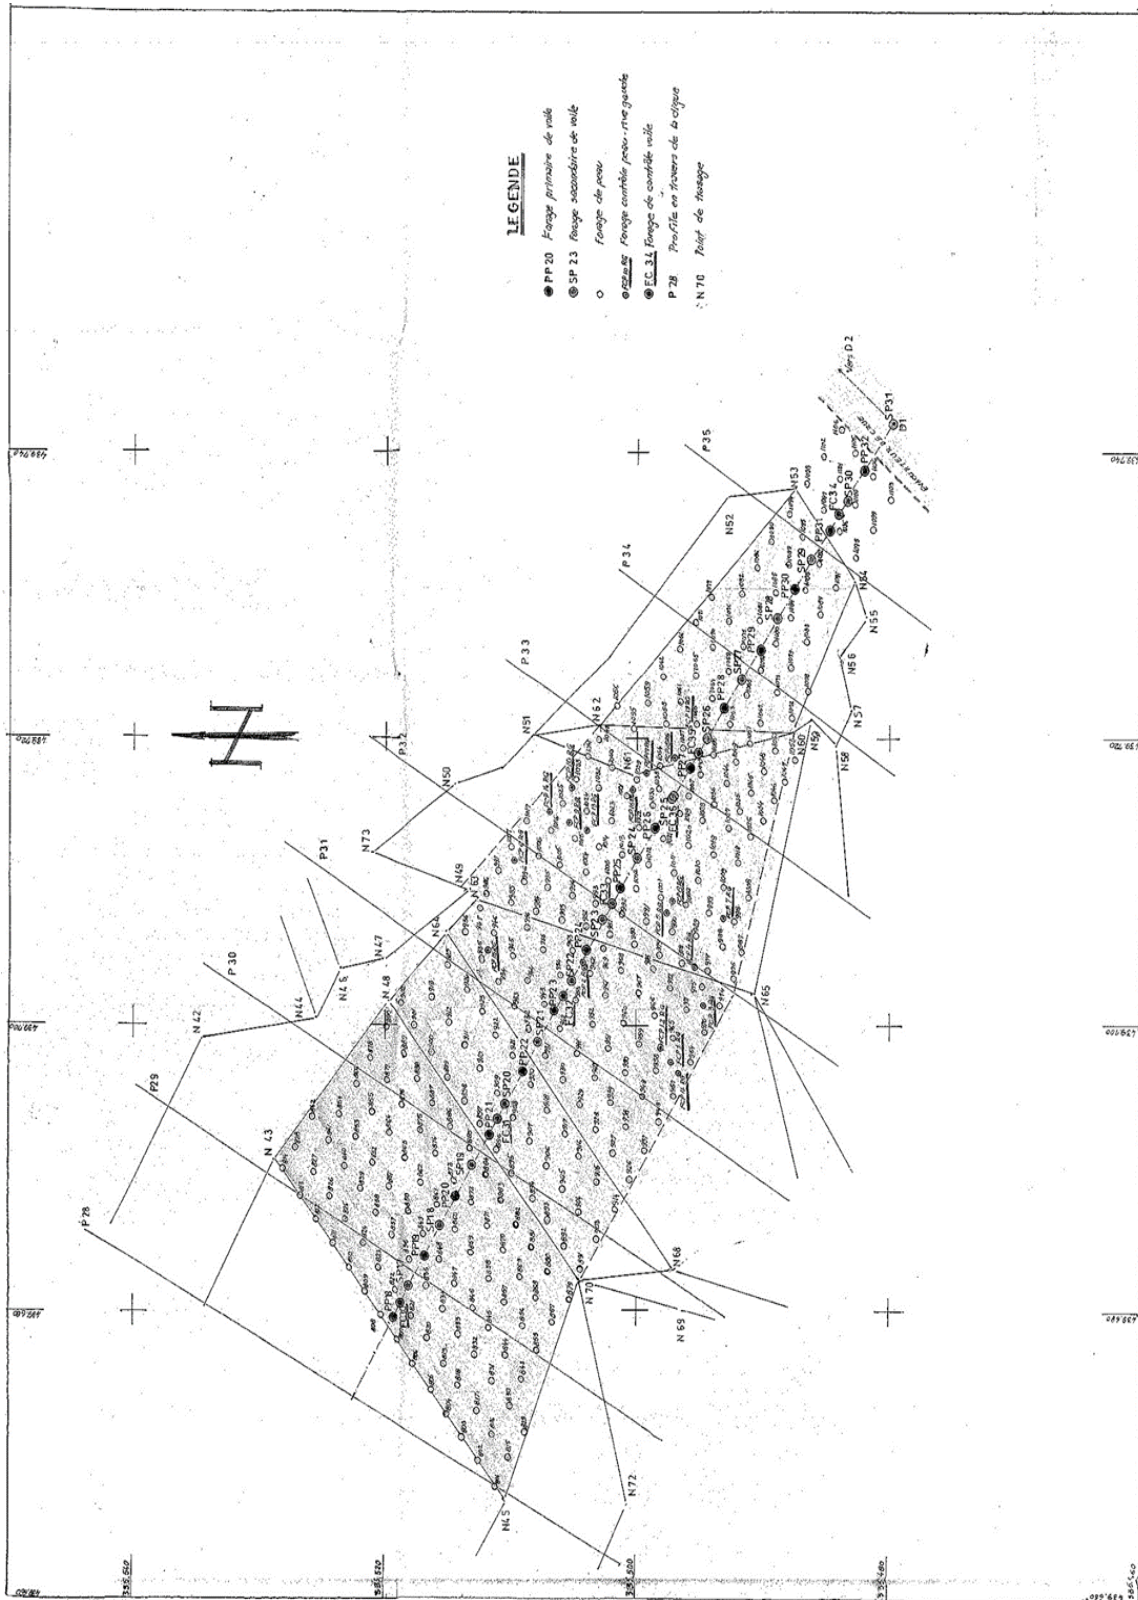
vue en plan du voile d'injection du barrage de SMBT.
